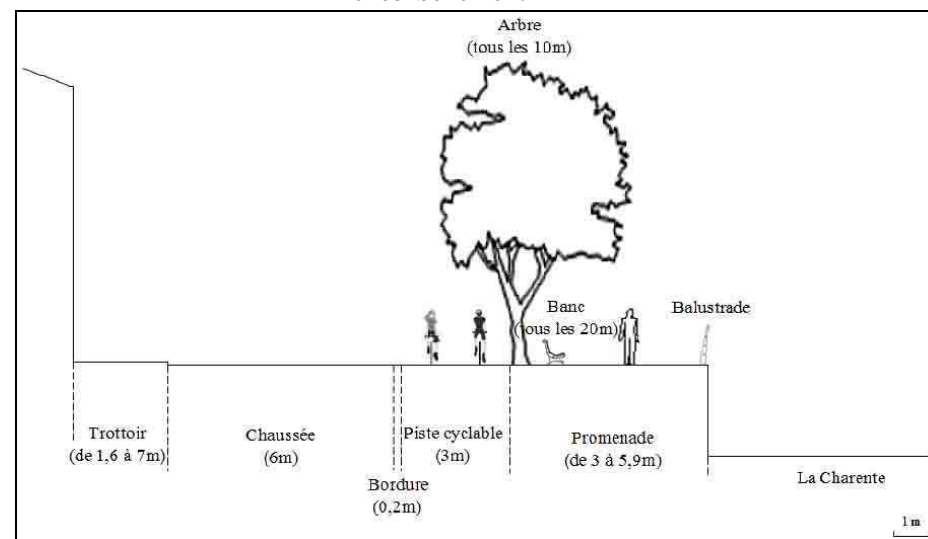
Profil de voirie n°4 - Sans stationnement et sans encorbellement
